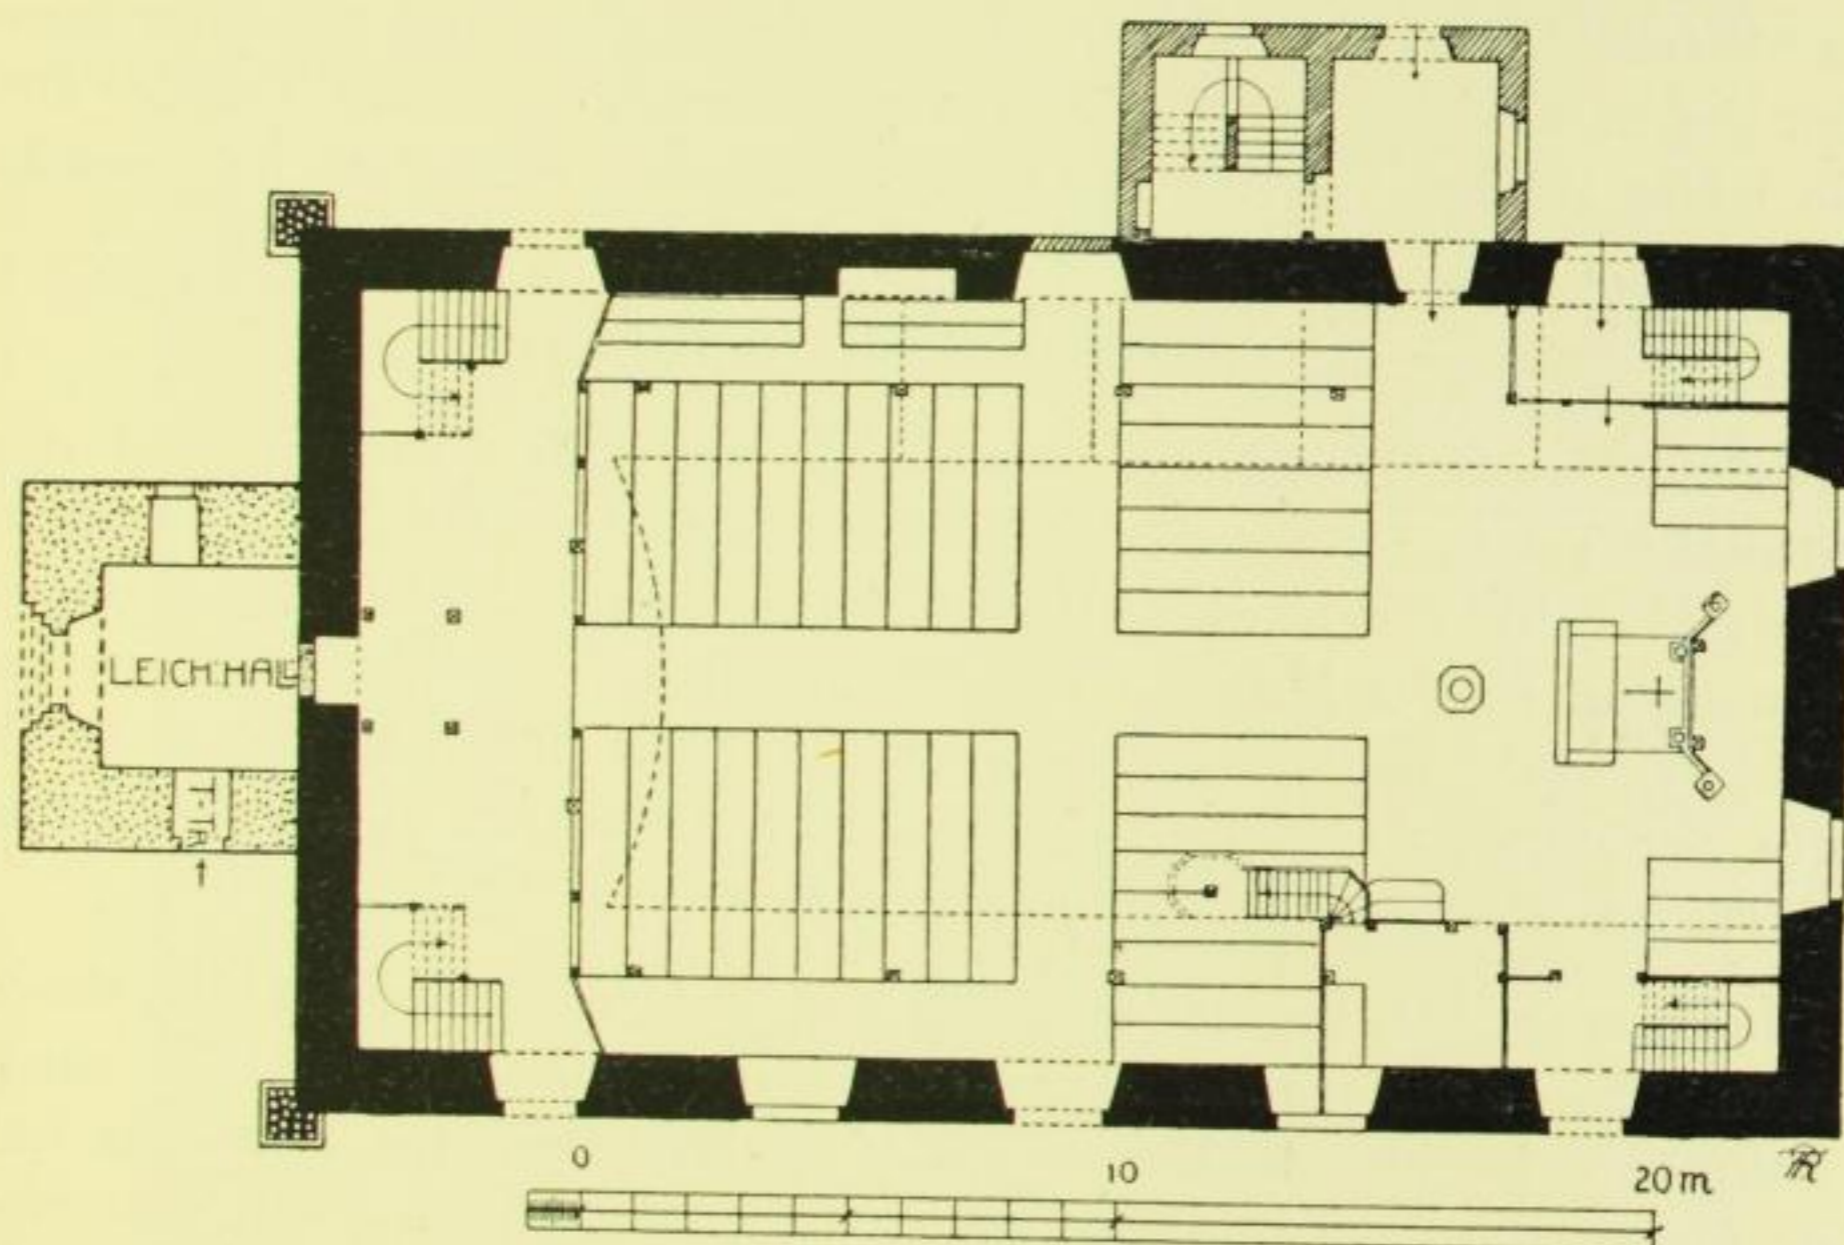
Kottmarsdorf, Kirche, Grundriß.
